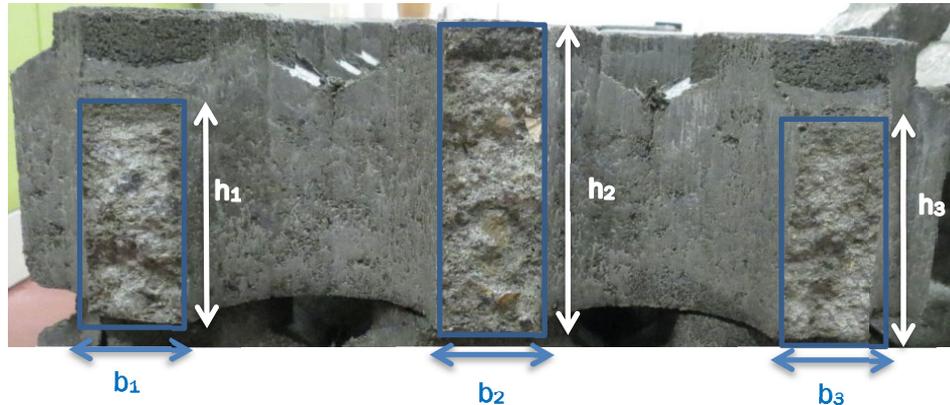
Sections de rupture d'une dalle drainante engazonnée ou gravillonnée
